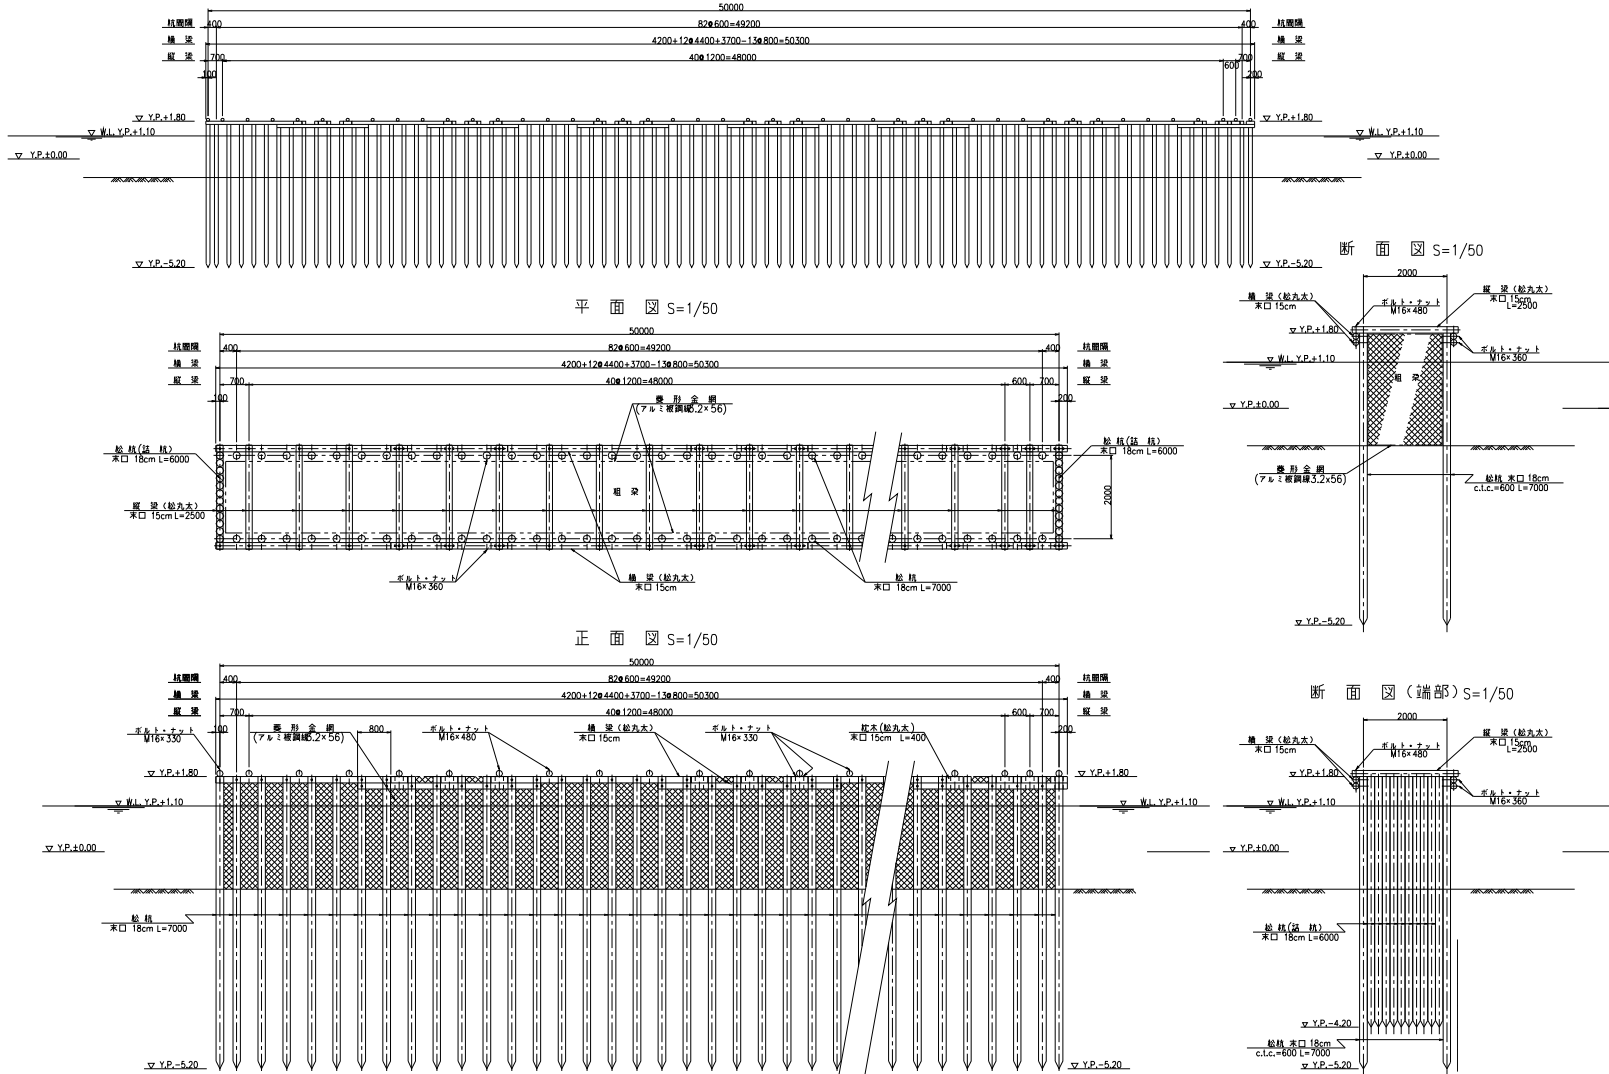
粗朶・捨砂工区 (下流) 平面図
